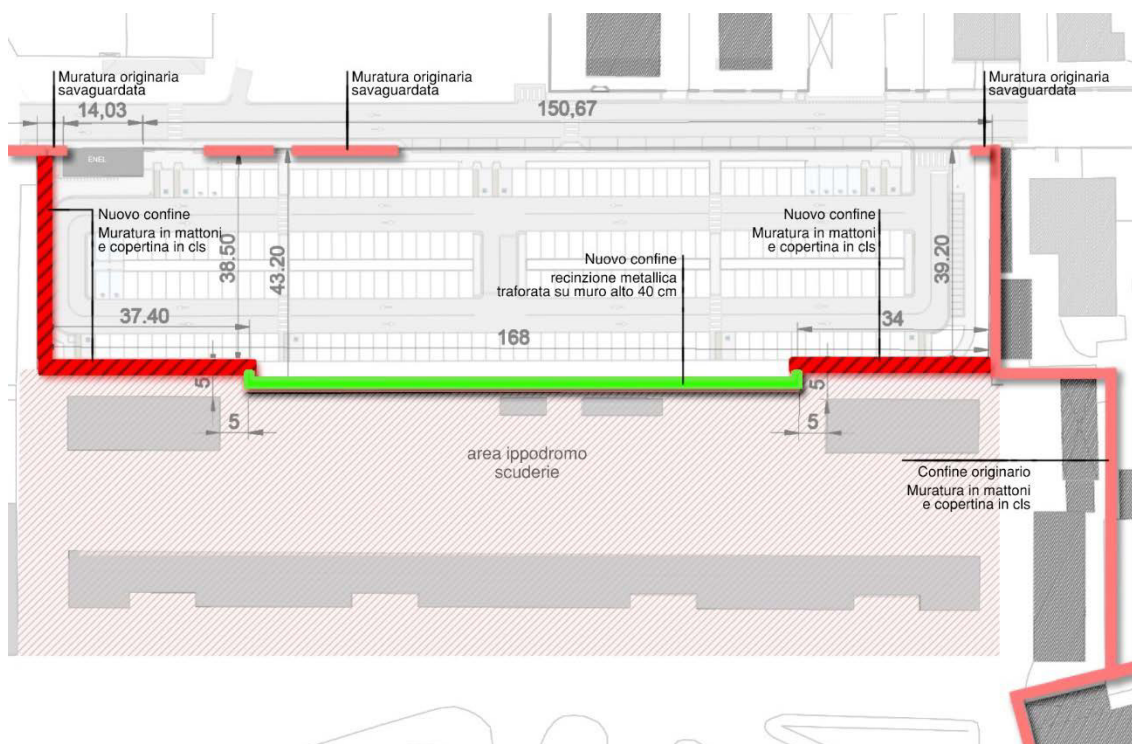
Stralcio planimetrico del parcheggio con, in evidenza le parti di muro mantenute e la giacitura della nuova recinzione a sud.
